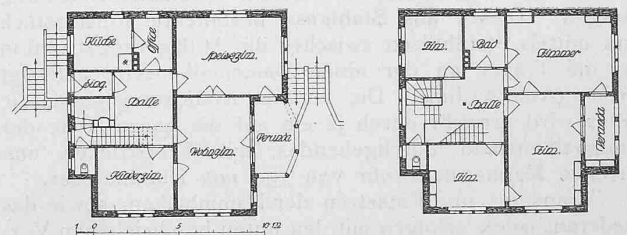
und 9. Grundrisse. — 1:400.
